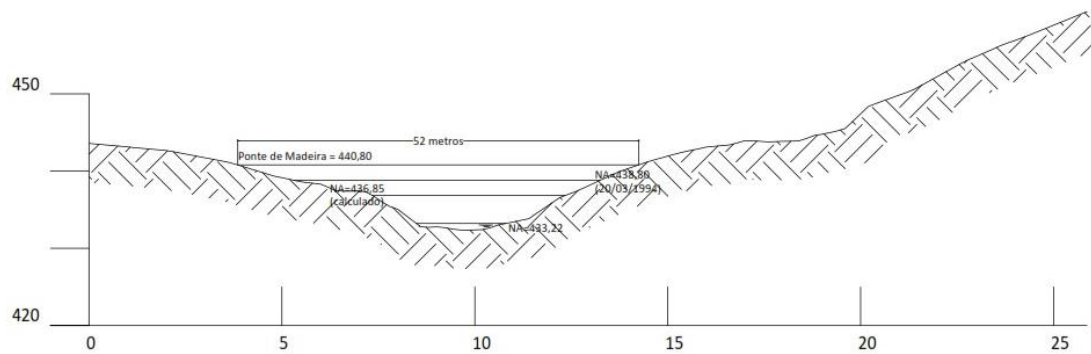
Seção no local de implantação da ponte sobre o Rio Sobretudo (Vão livre de 52,0 m)
